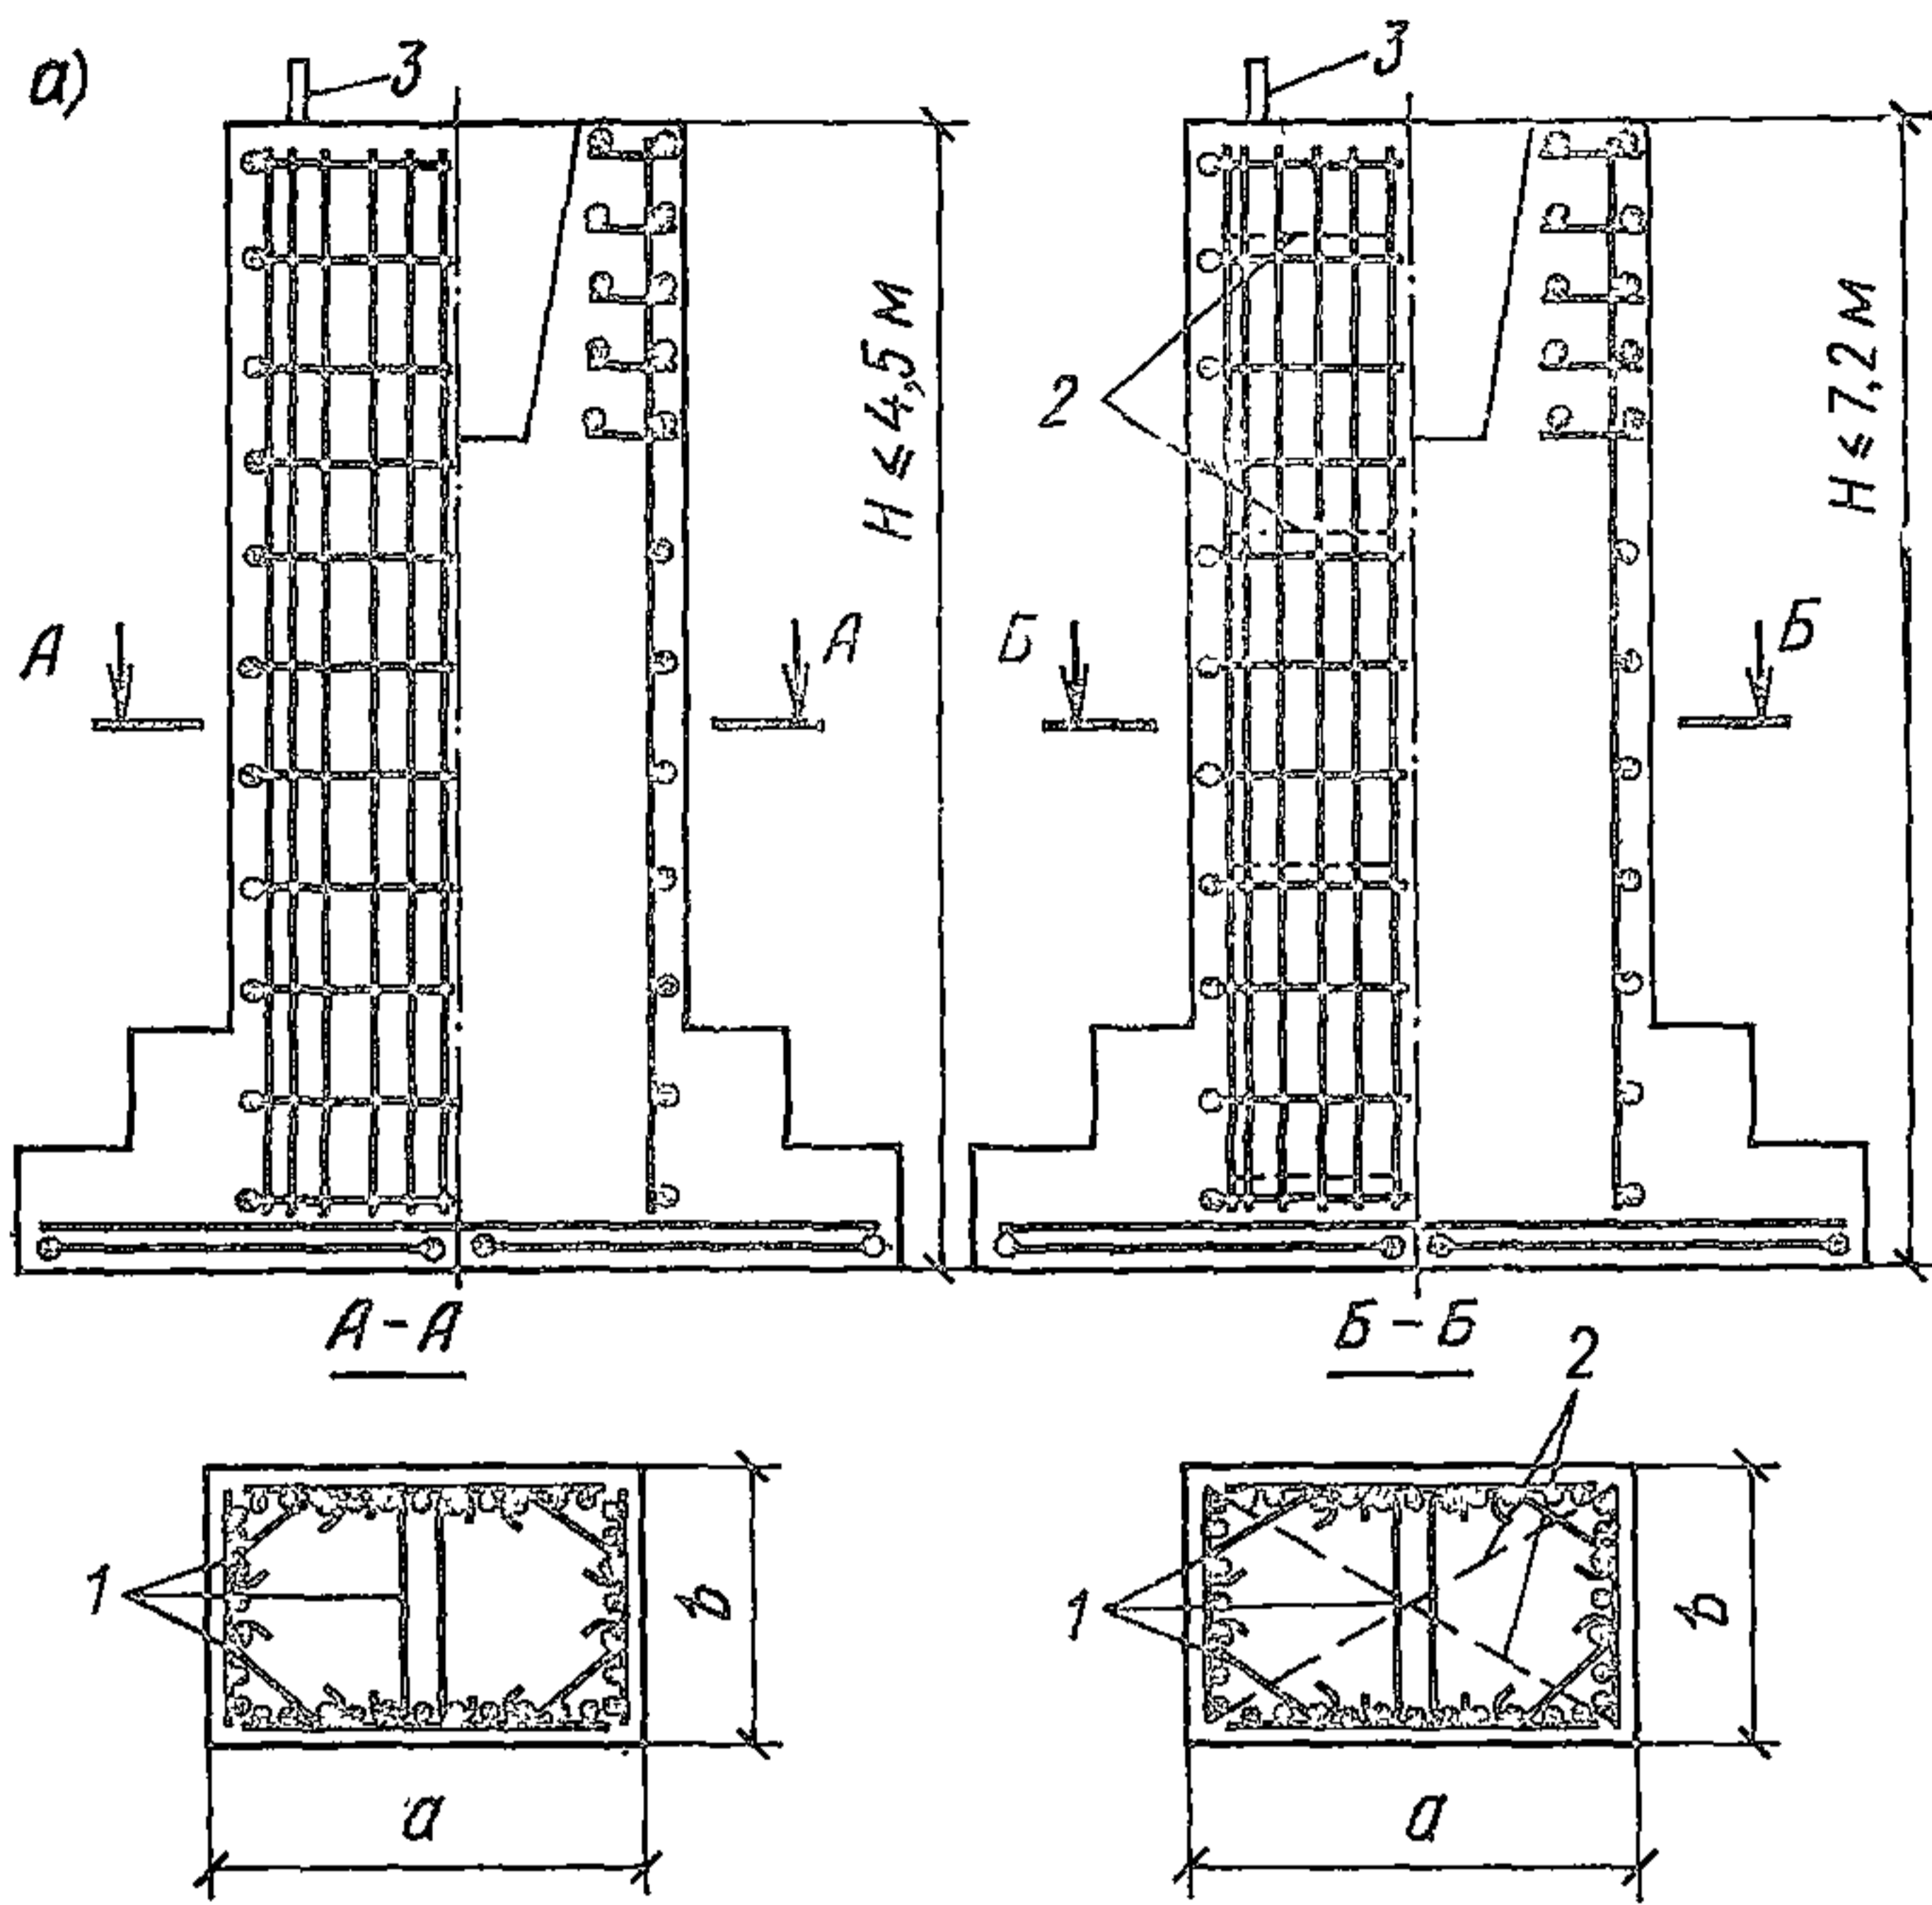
Армирование фундаментов колонн пространственными само-несущими арматурными каркасами, собираемыми из плоских сеток *a* — при высоте фундаментов до 4,5 м; *б* — при высоте фундаментов от 4,5 до 7,2 м; 1 — шпильки (через 600 мм по высоте); 2 — горизонтальные арматурные связи (через 1800 мм по высоте); 3 — анкерный болт под стальные колонны
